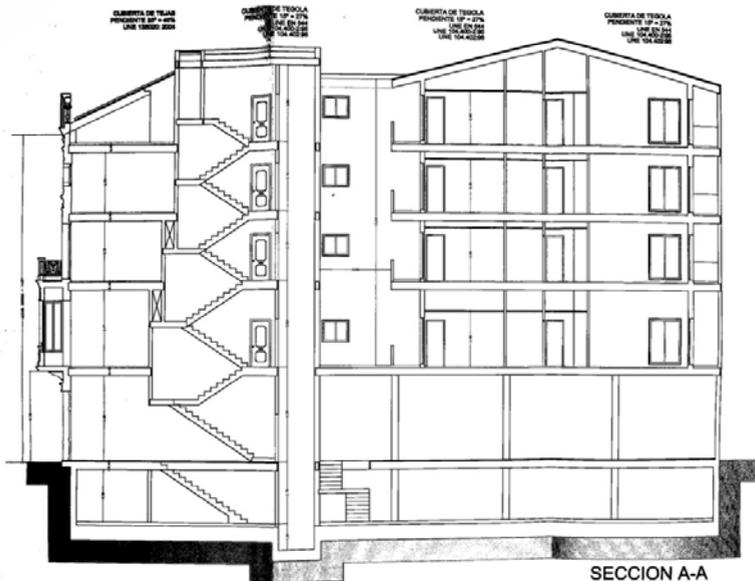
Sección longitudinal. 2008. Proyecto de ejecución.
